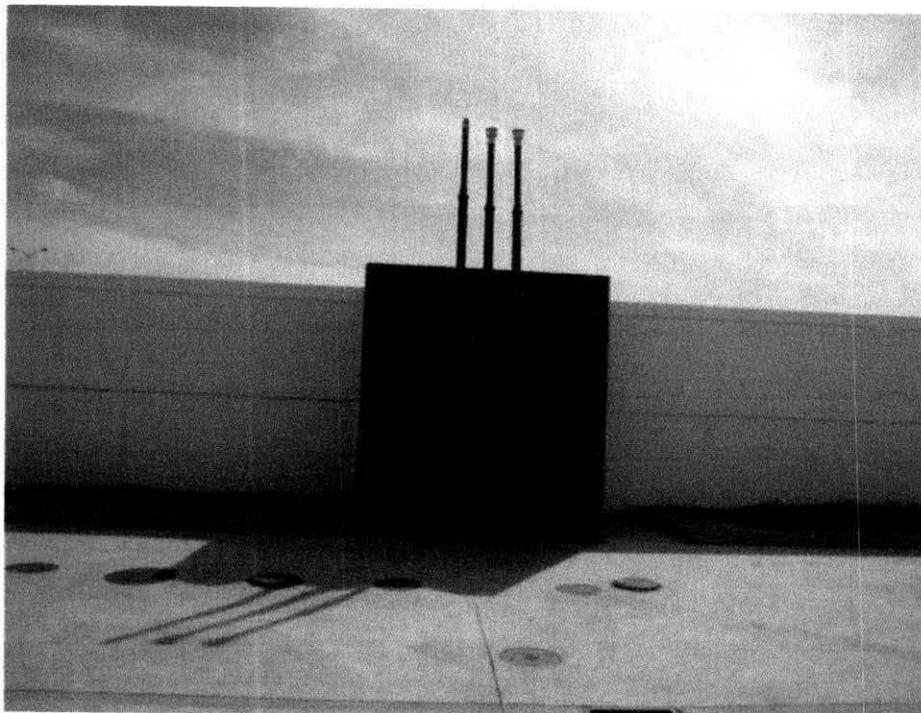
Vista de la Zona de Tanques.
